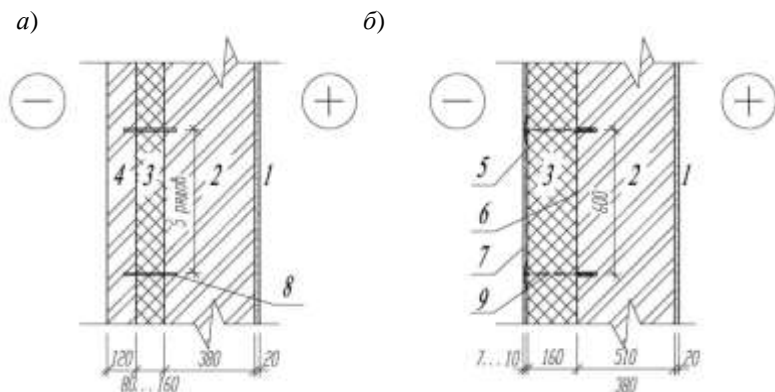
Схемы устройства слоистой кладки наружных стен:
